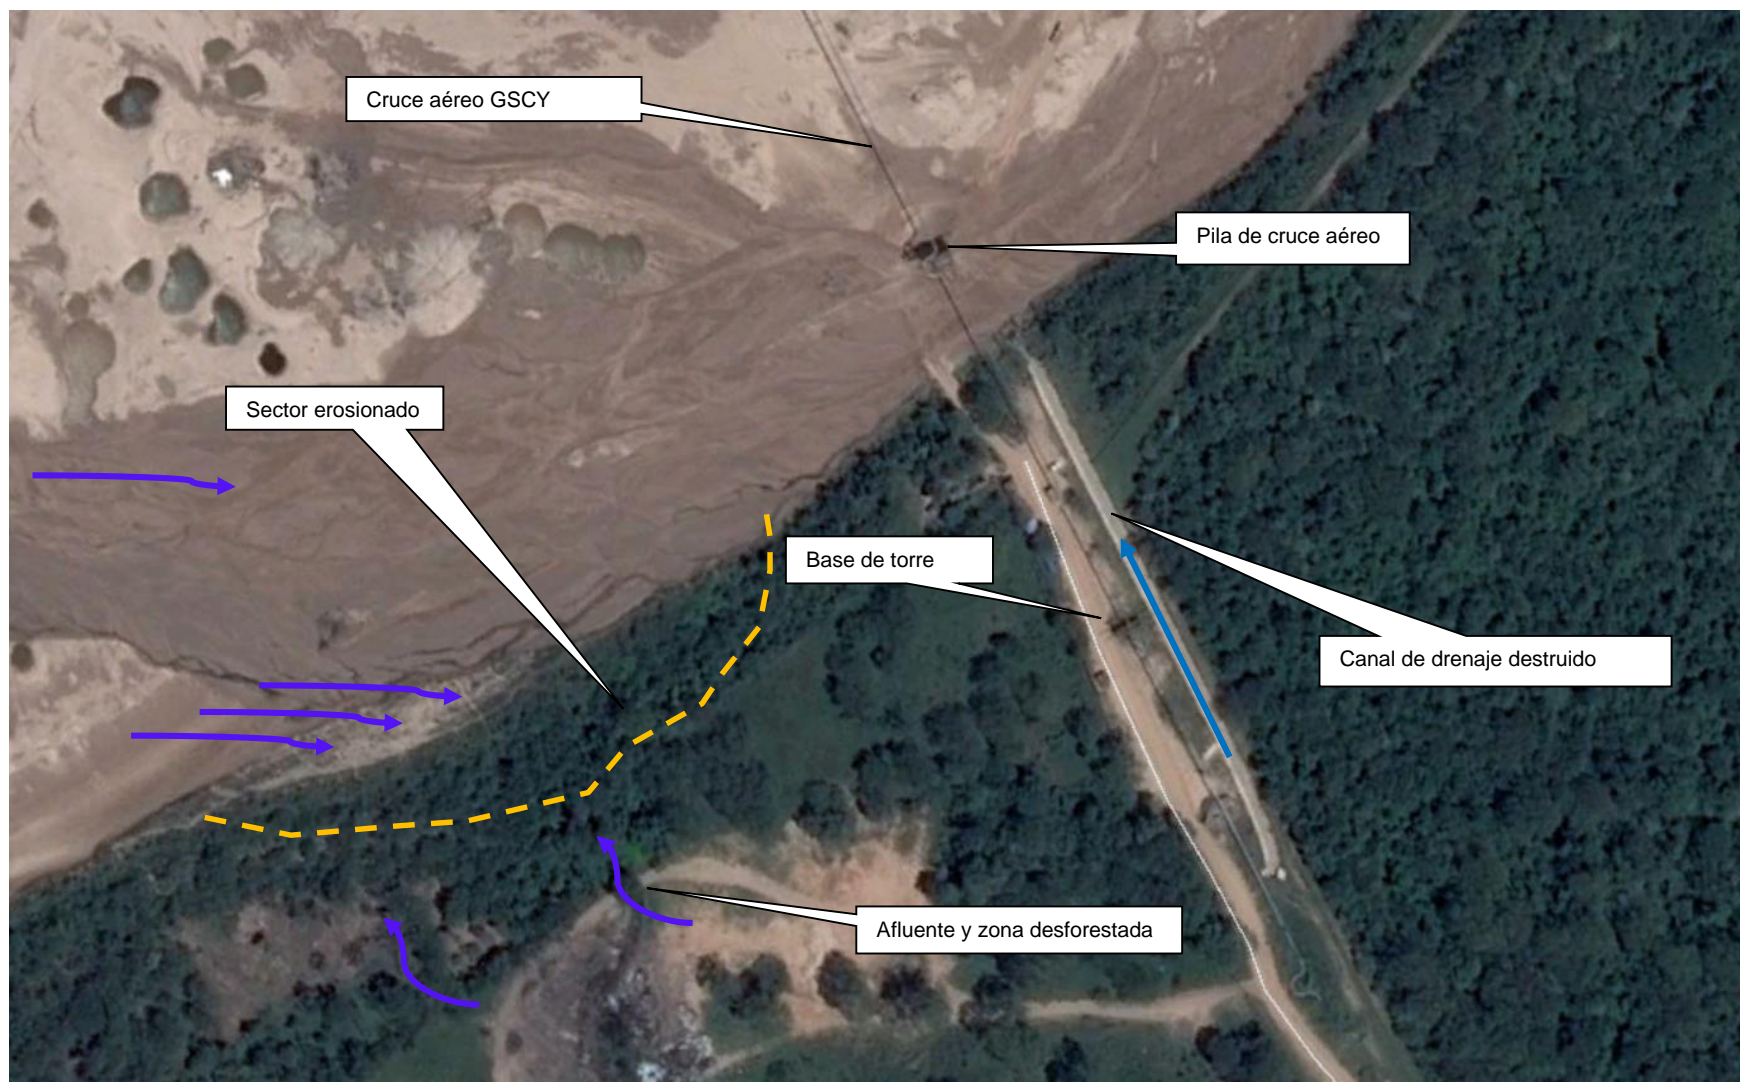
Detalle emplazamiento de las obras del cruce aéreo del ducto GSCY
